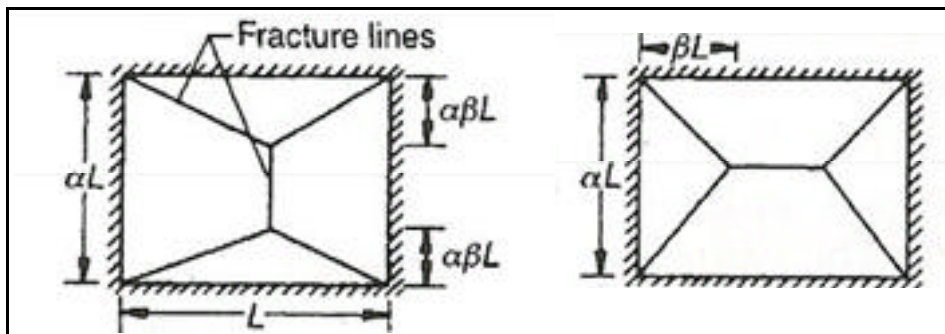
Lignes de fracture d'un mur en maçonnerie en façade.
